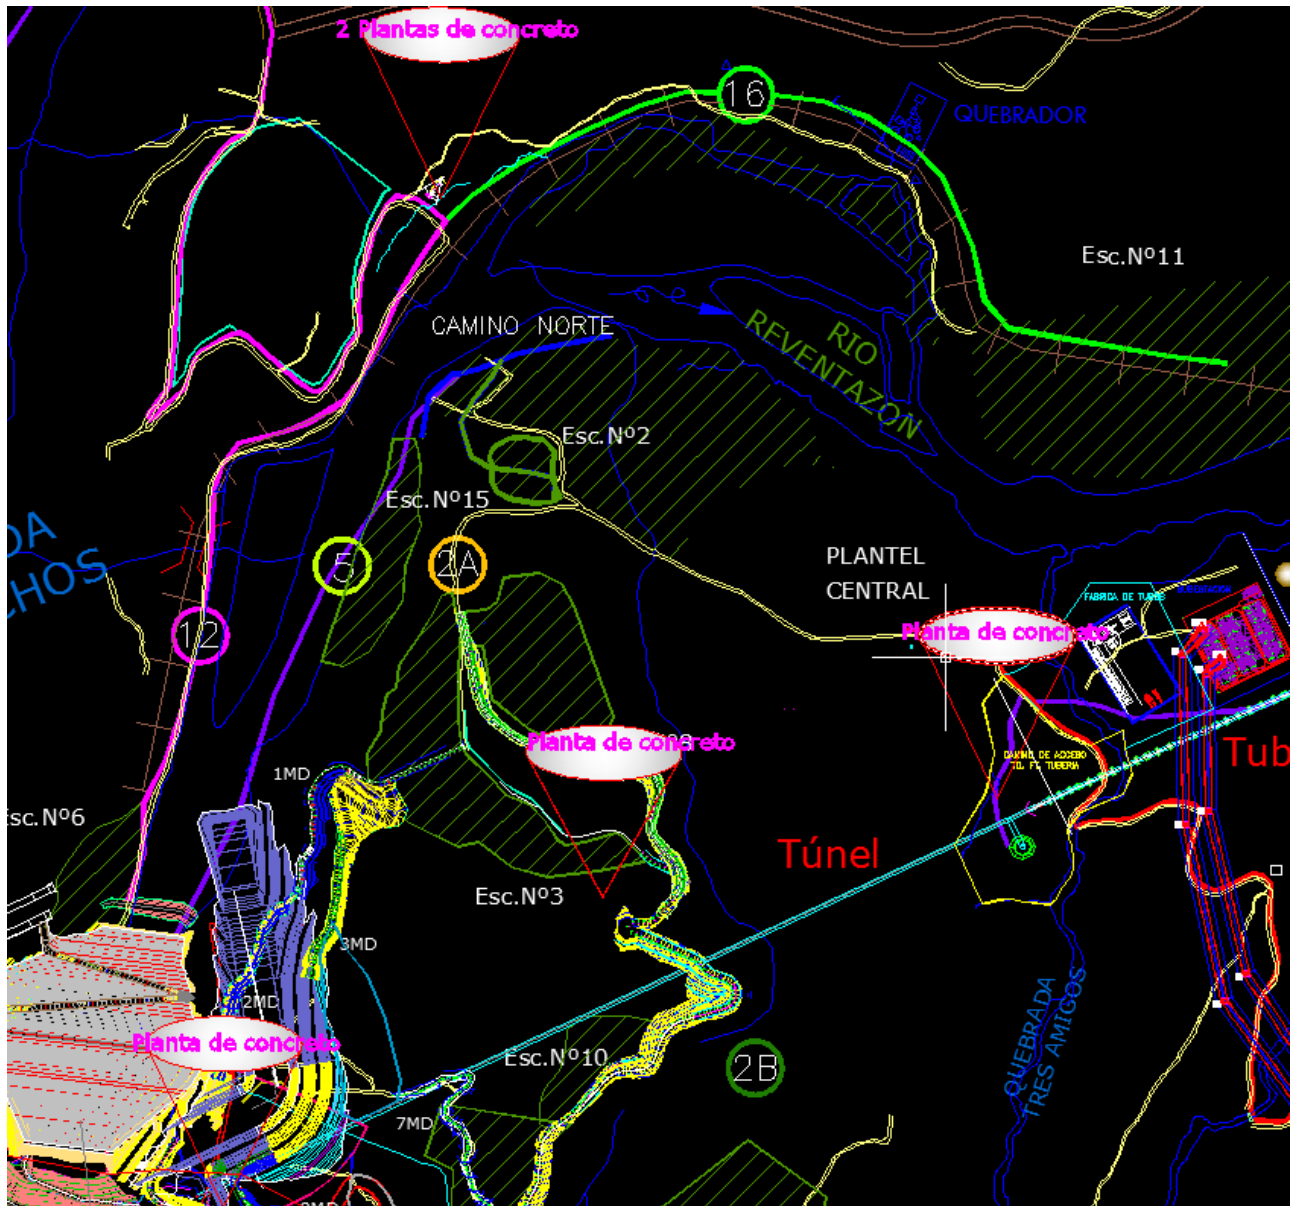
Ubicación de plantas de concreto para el escenario 2.
